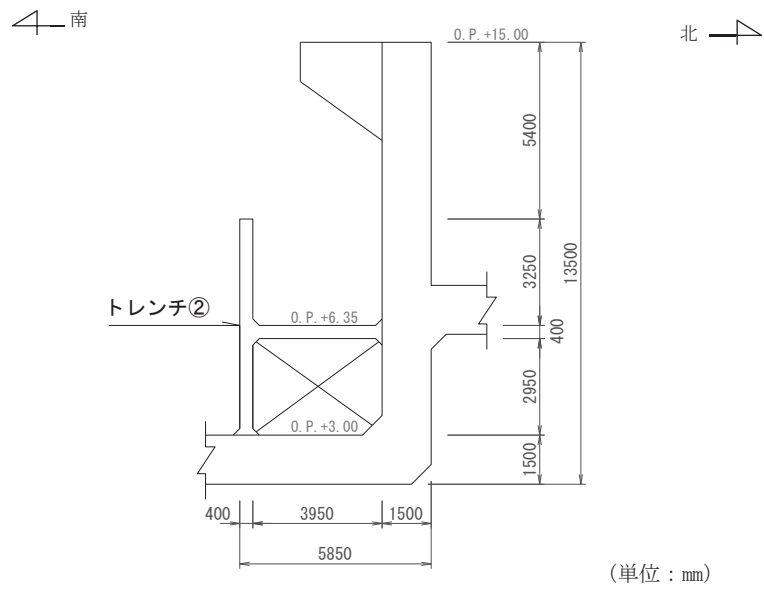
(8) 補機ポンプエリア断面図 (⑧—⑧断面)
